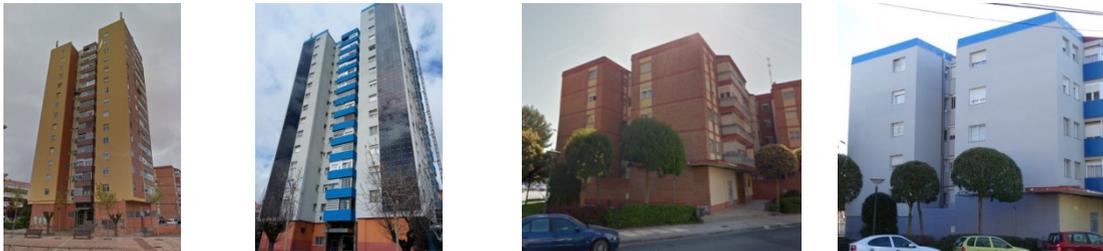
Aislamiento de fachadas y cubiertas (antes y después de la intervención)
